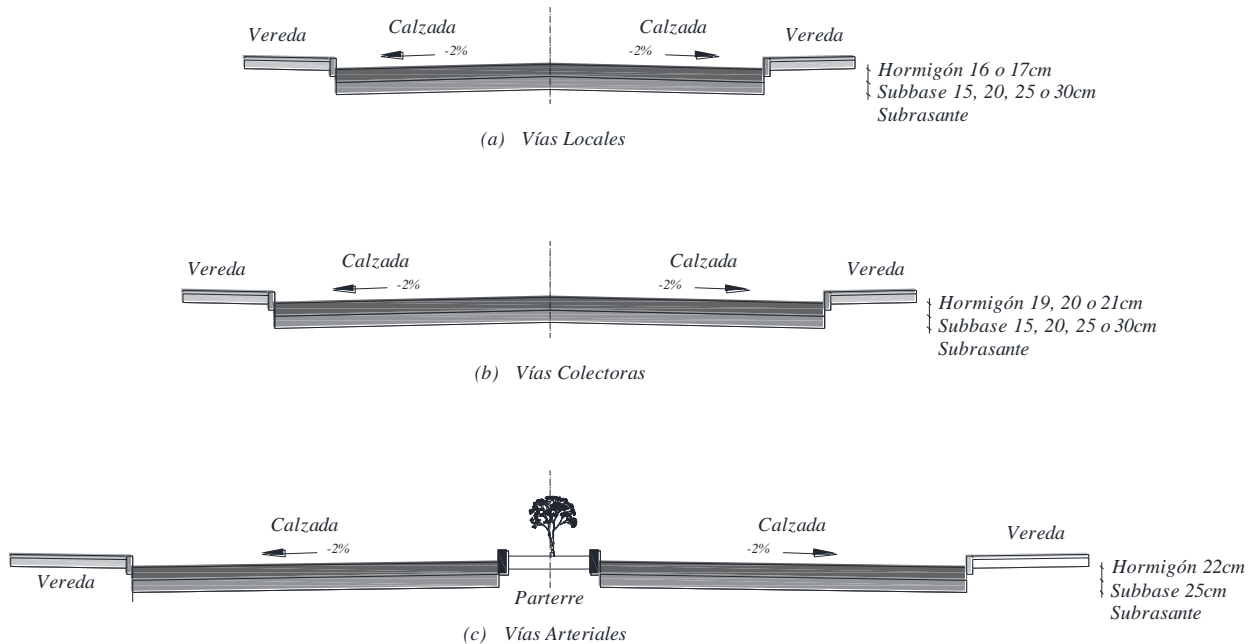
Estructuras típicas de pavimentos rígidos consideradas en los diseños
